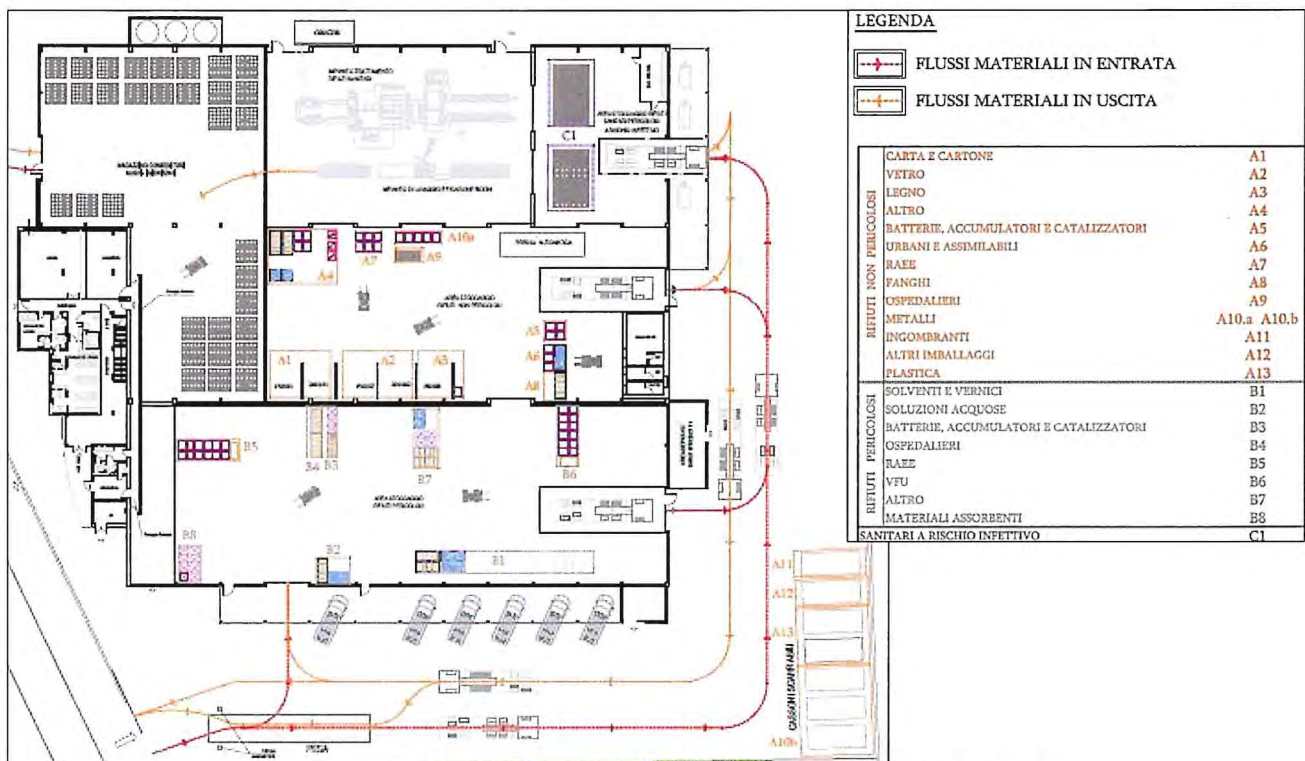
Planimetria aree di stoccaggio rifiuti (da elaborato 10-PRD4 allegato allo SIA)
